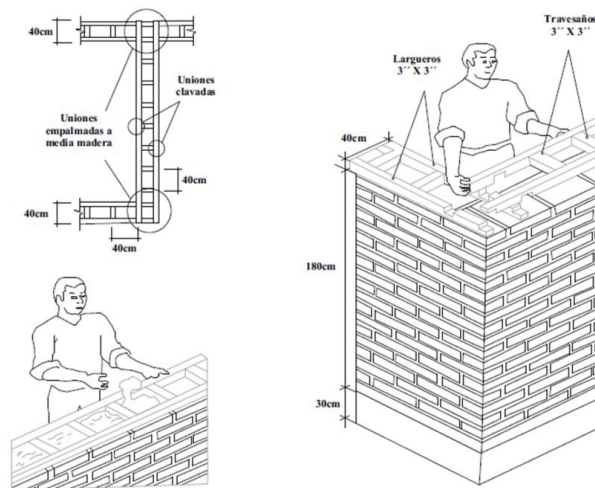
Forma de construir una viga collar para el refuerzo estructural del muro de adobe Fuente. Arqta. Birmania Giles Castillo Elaboración. Francisco Piedra Año 2018
